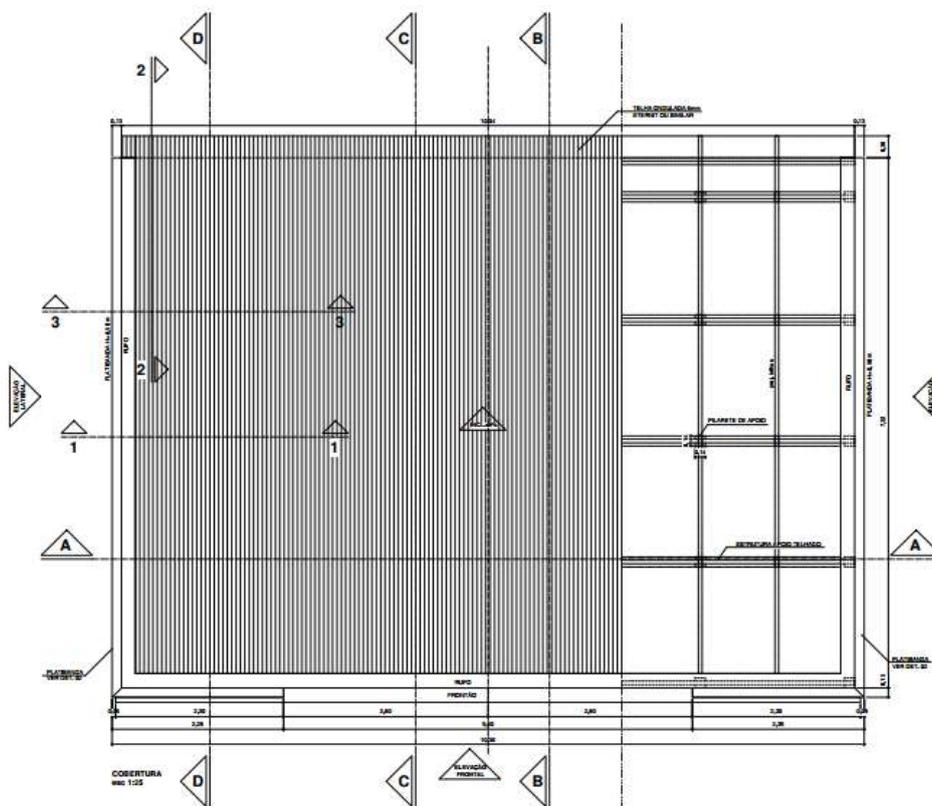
Planta da cobertura - Casa 3 quartos (Fonte: Consórcio Jardins Mangueiral)
